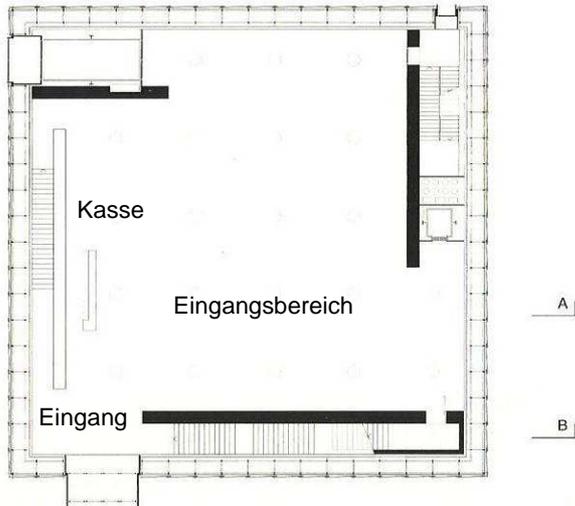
Kunsthaus Bregenz, Grundriss Erdgeschoß 1:500
